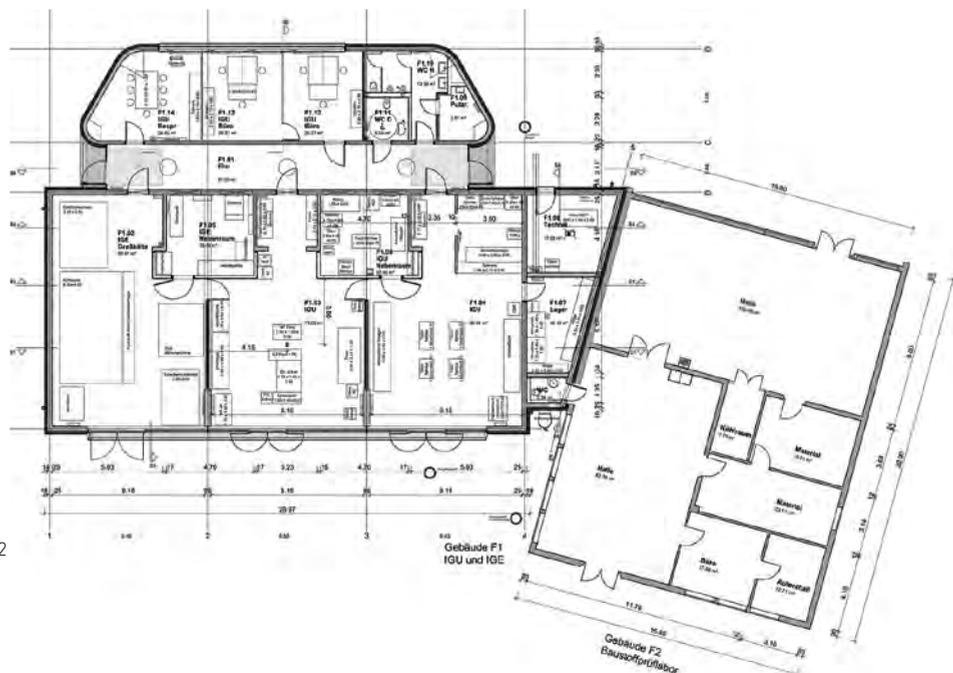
Grundriss EG, Gebäude F1 und F2
